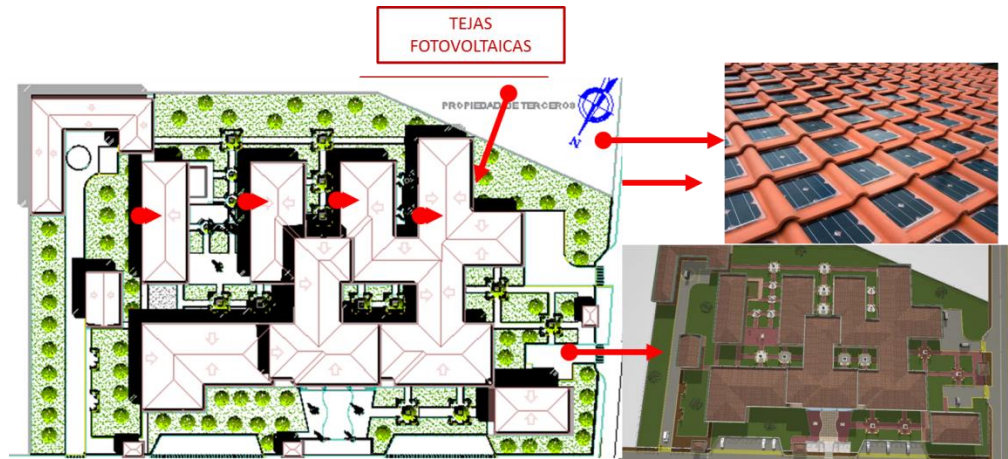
Planteamiento del proyecto teja fotovoltaica; Fuente: elaboración propia.
